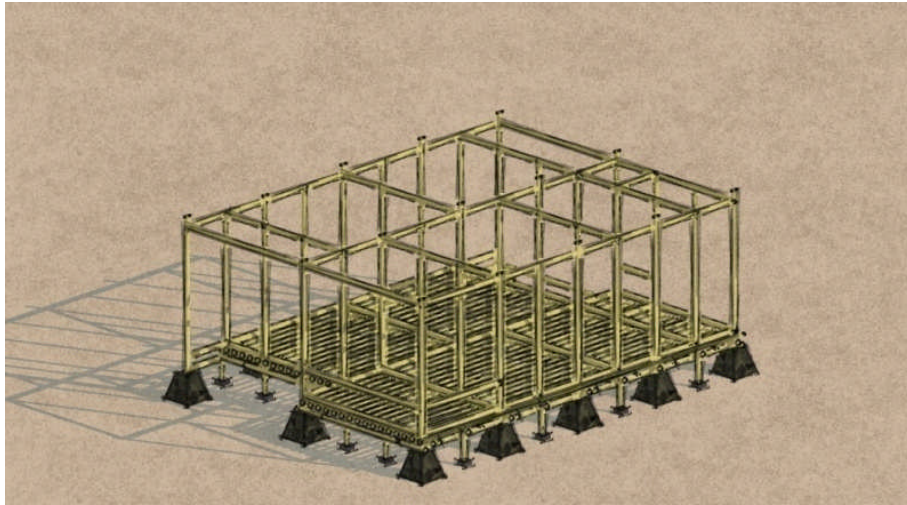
20. Pemasangan Balok Lantai dan Tiang Panggung
